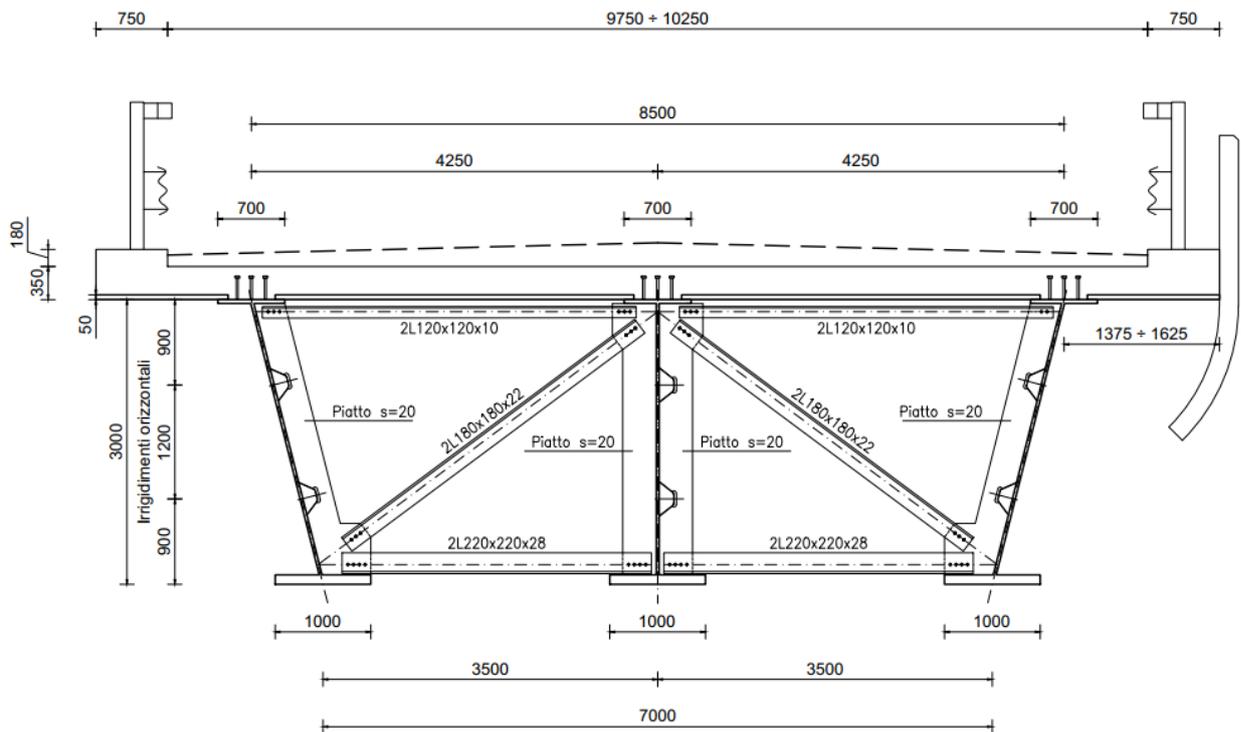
Sezione Strutturale Tipo del Viadotto Tevere
